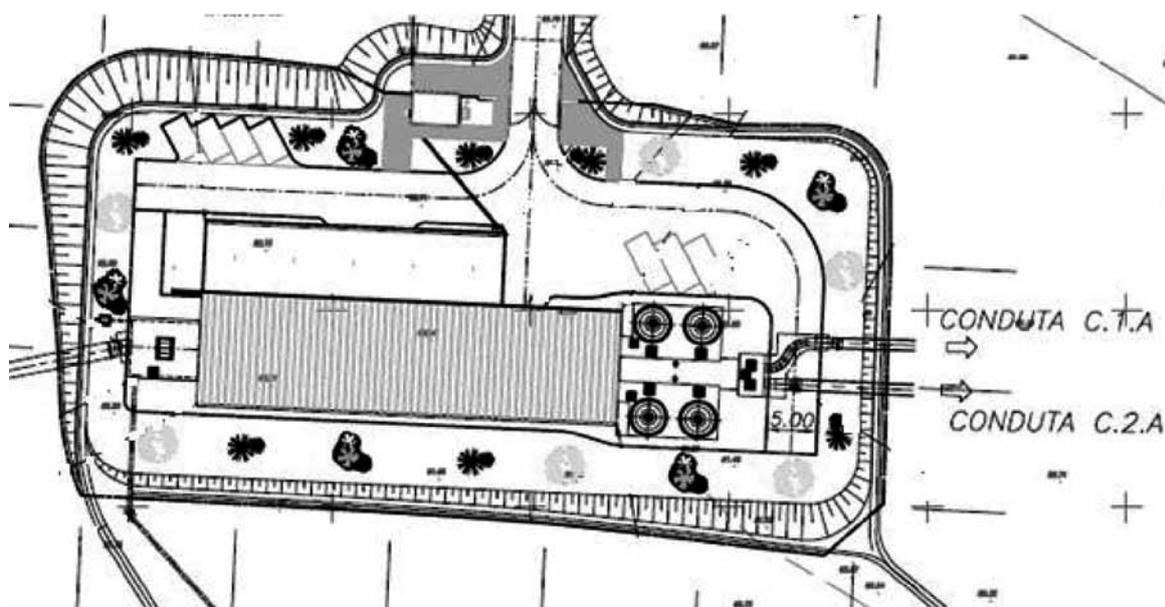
Planta Geral de uma EB com Grupos de Câmara Seca e Adução por Conduta
